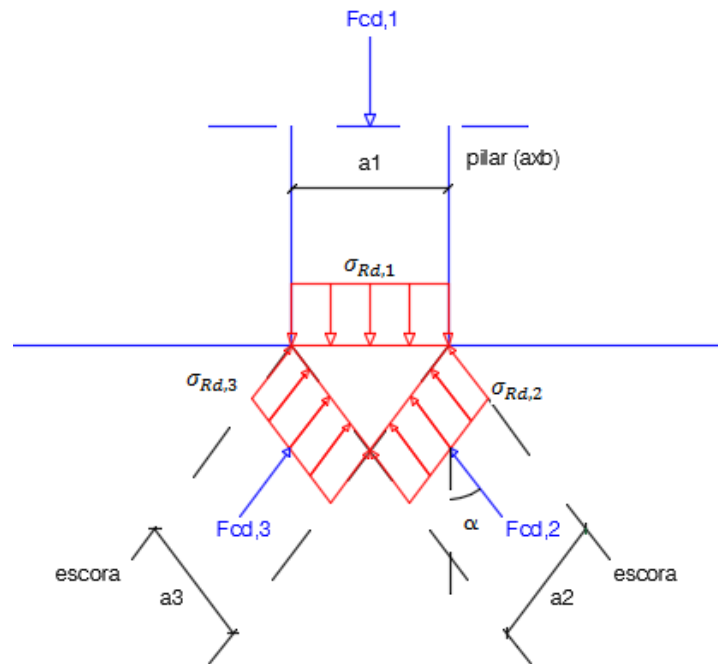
Nó junto ao pilar. (Pouca, 2016)
